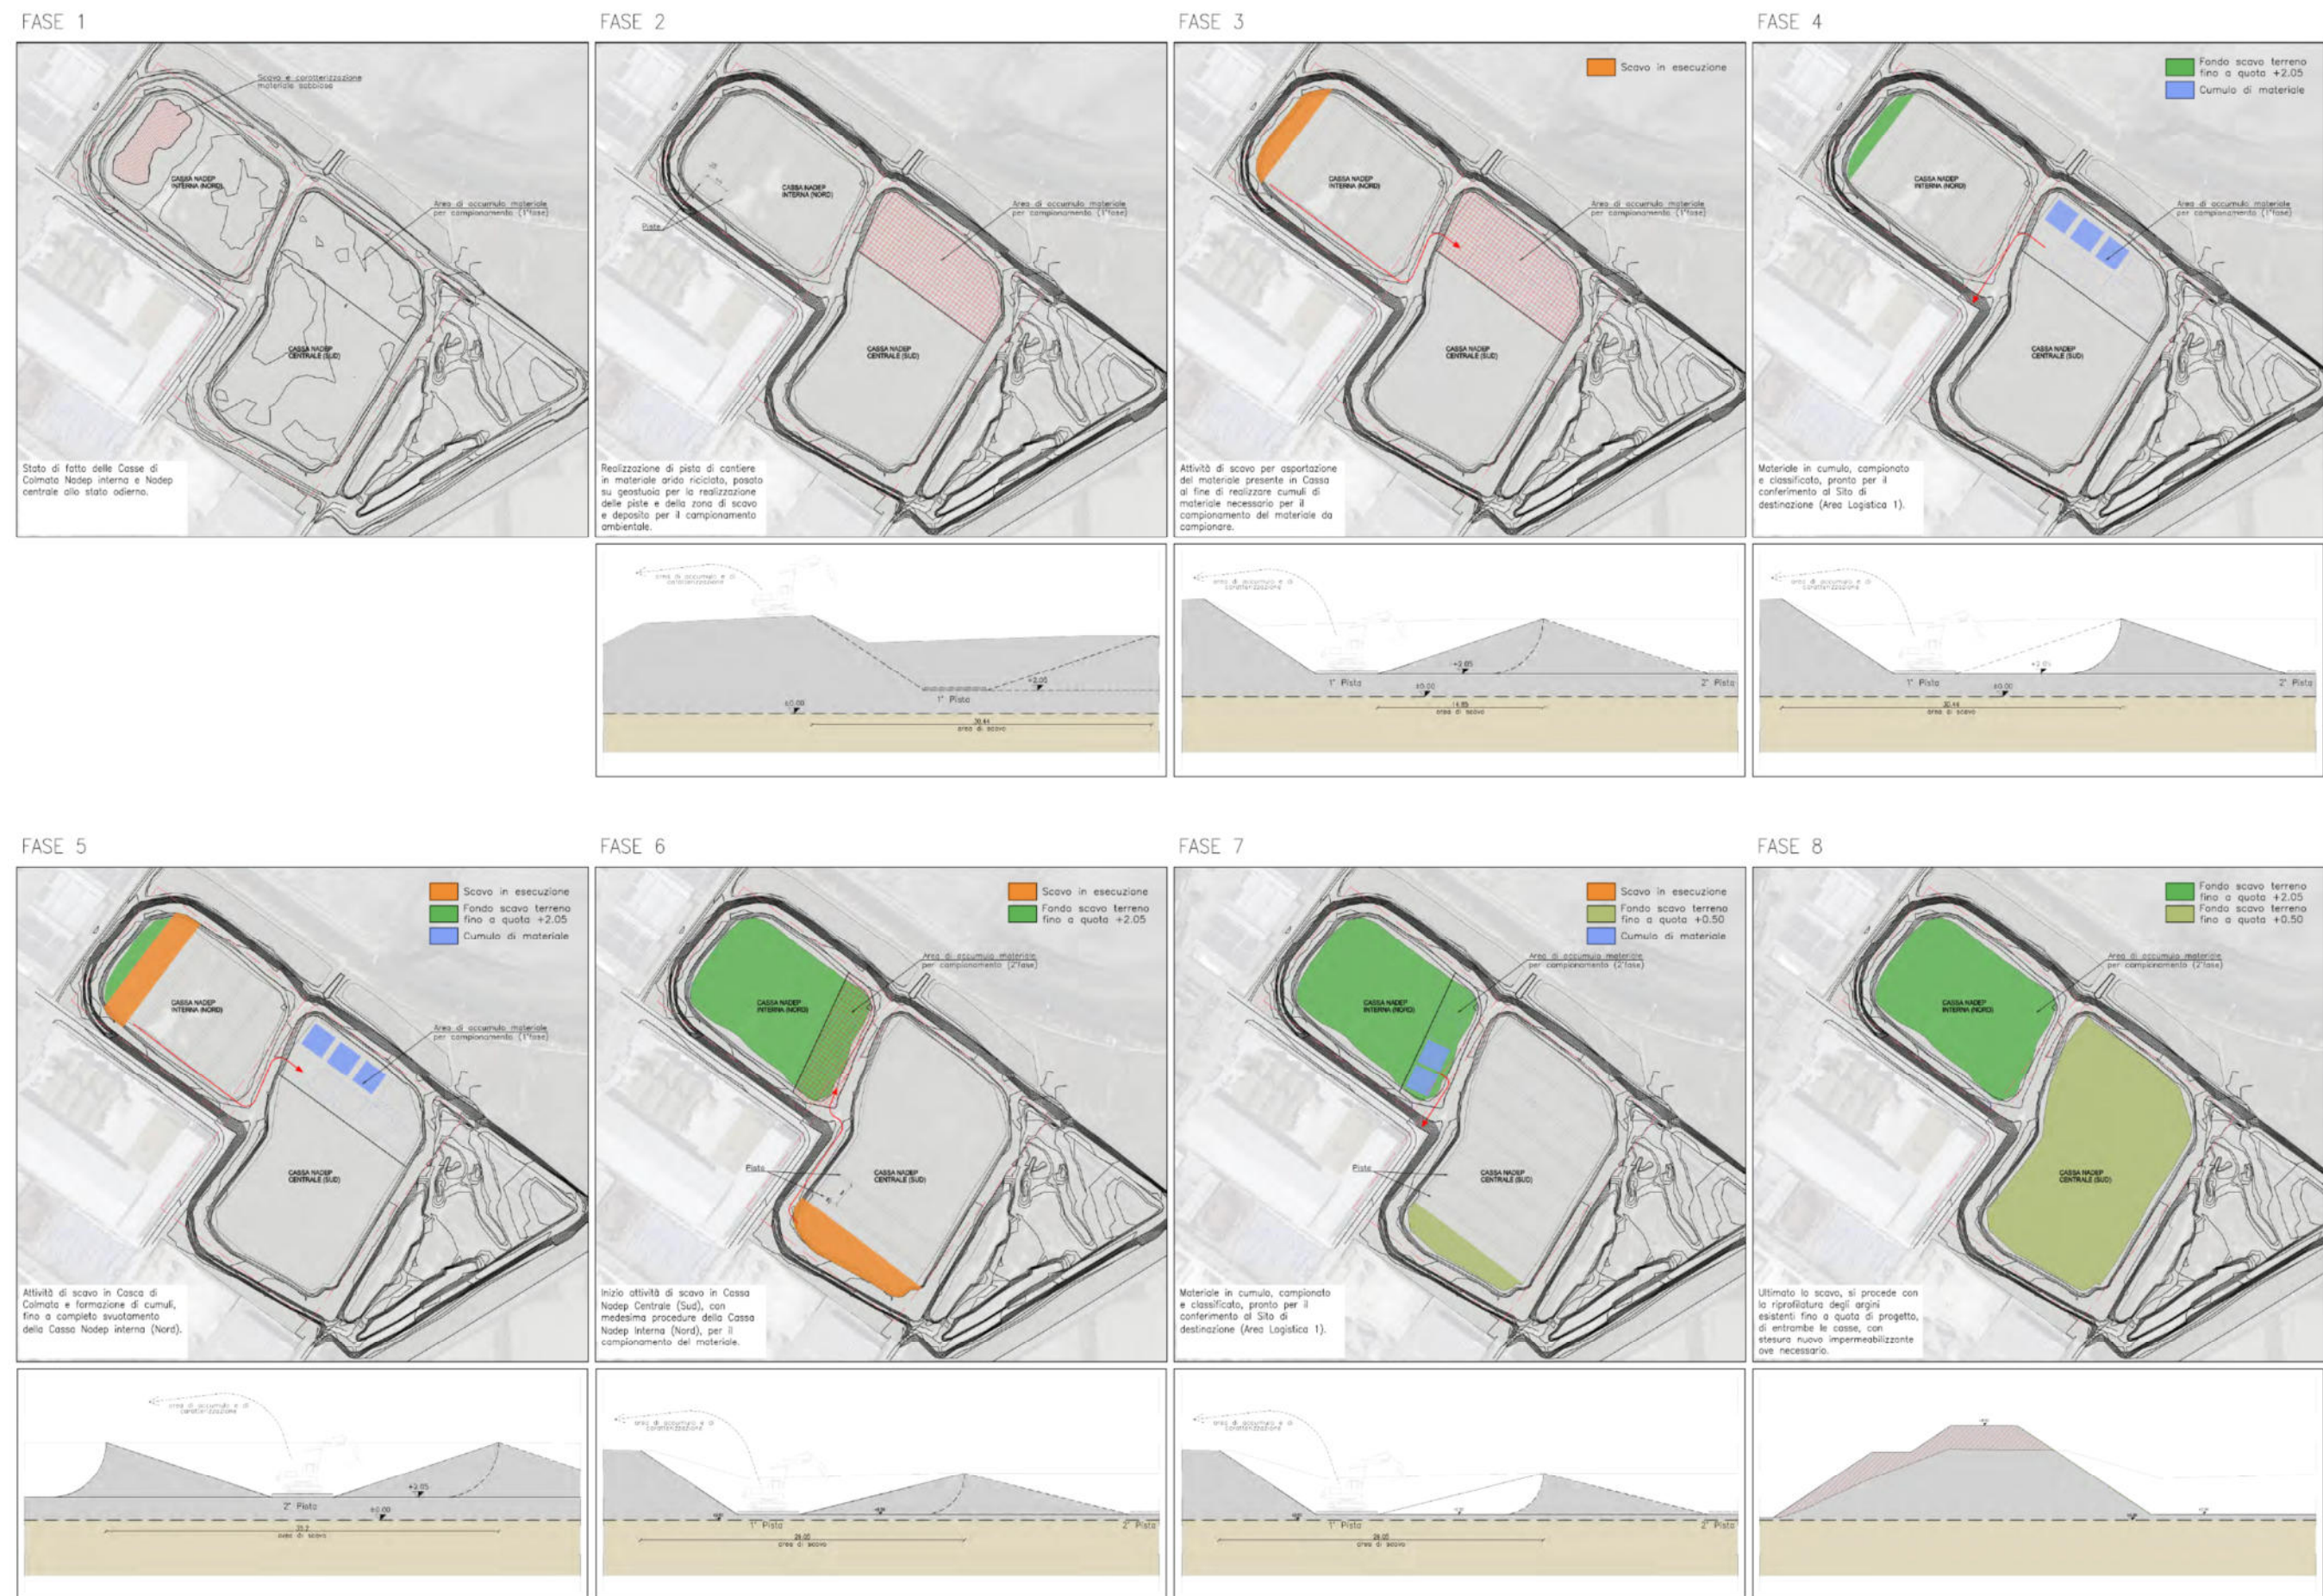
Stralcio dell'elaborato "AMB 2 – Planimetria delle fasi di scavo della Cassa di Colmata" del progetto "Svuotamento cassa di colmata Nadop centrale e interna e rimodellazione degli argini"
